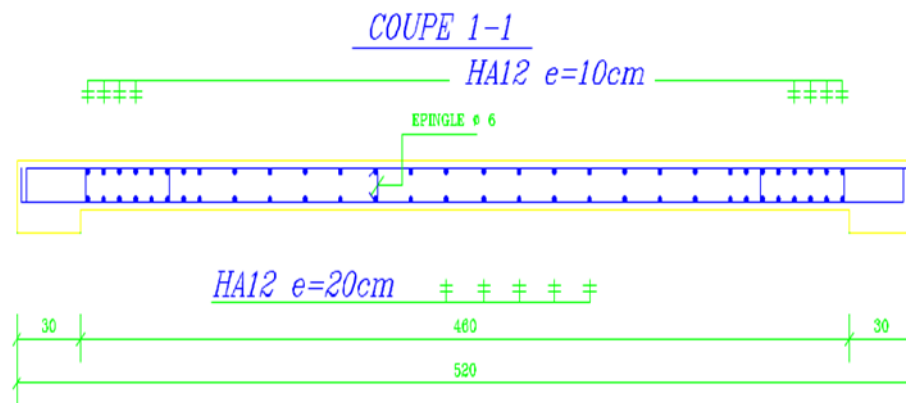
Schéma de ferrailage des voiles Pleine.
